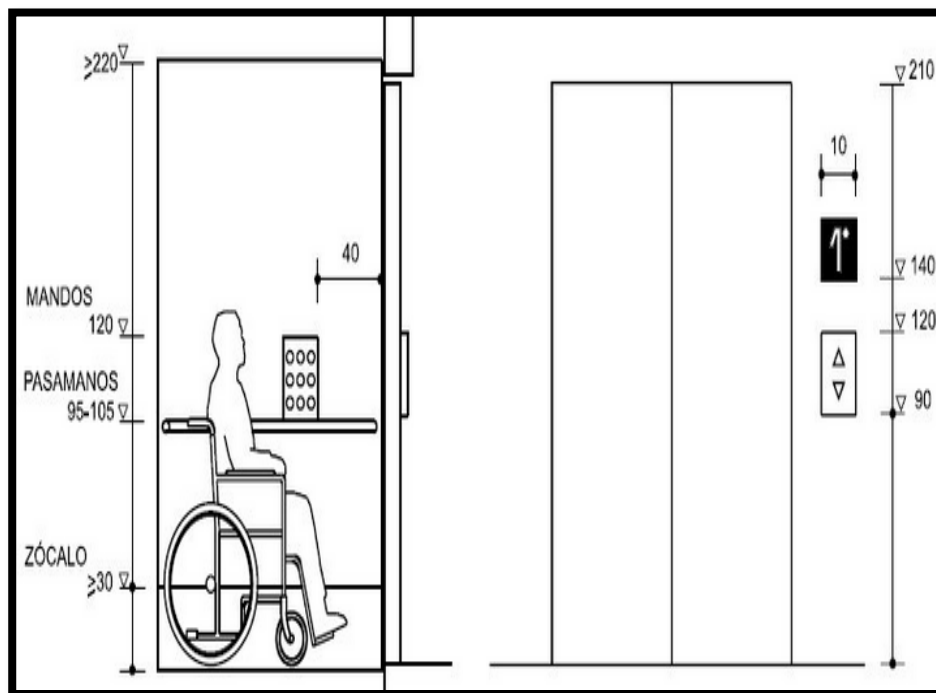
Dimensiones Mínimas para una persona en silla de ruedas.
